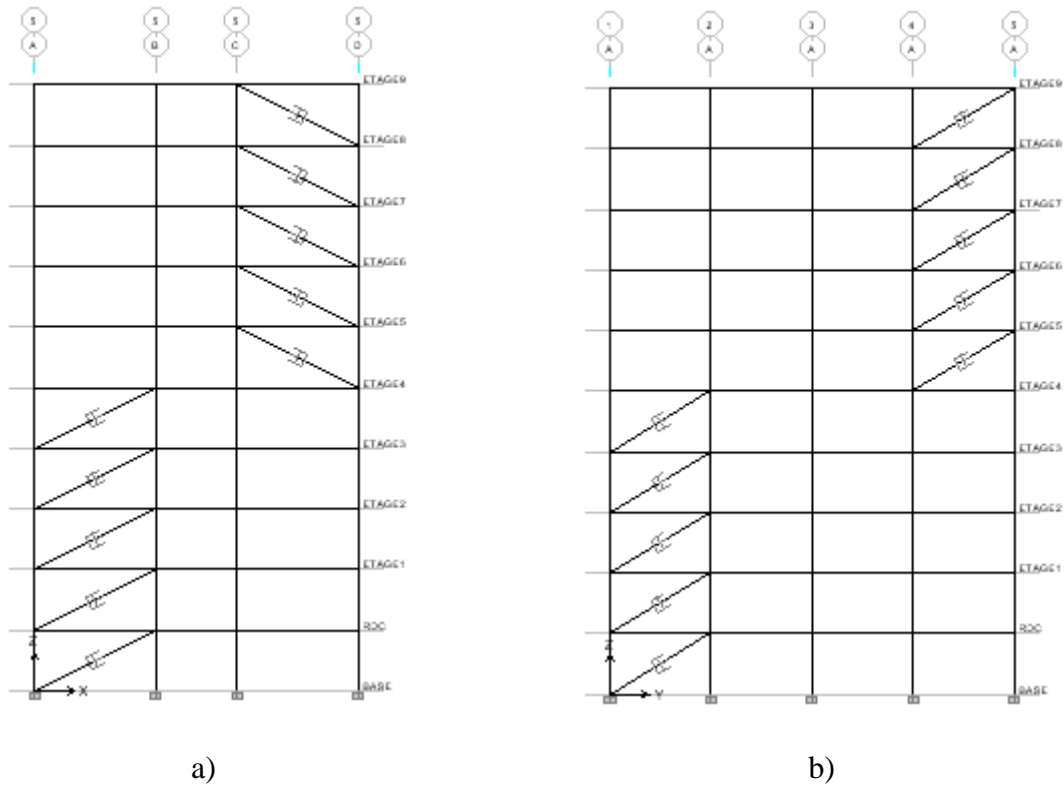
Coupes du Troisième proposition de la structure : a) Coupes A-A et A'-A' b) Coupe B-B et B'-B'
